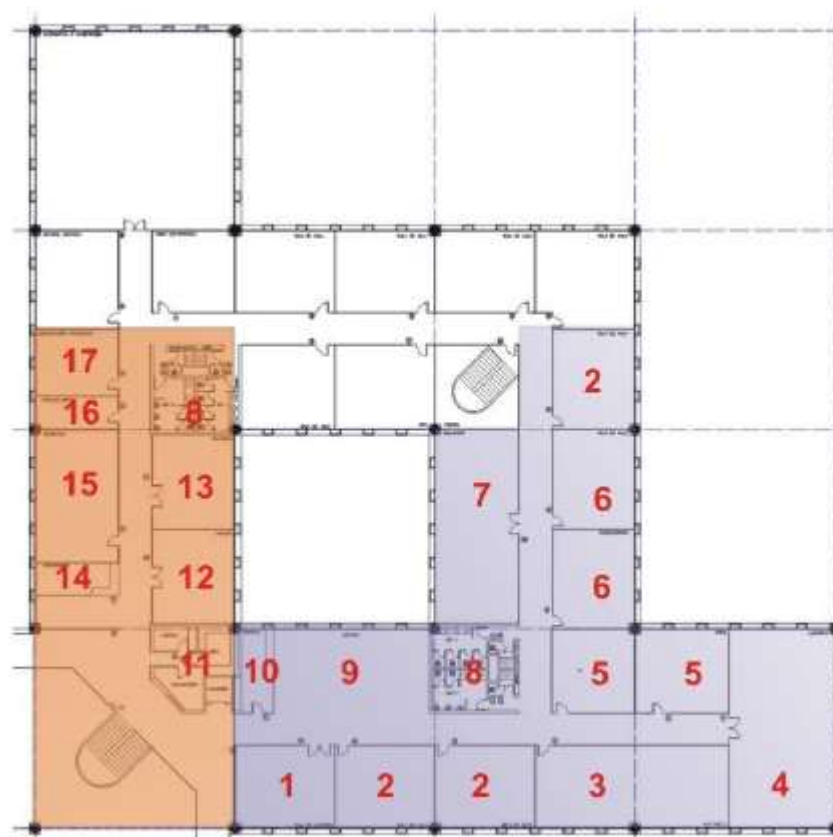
Planta Térrea SENAI (fonte: willer arquitetos)
